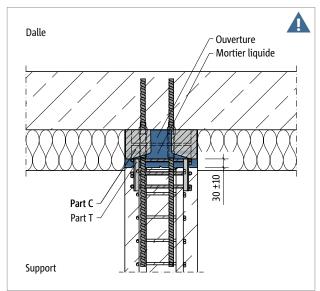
Schöck Sconnex® type P : coupe de montage ; raccordement poteau - dalle avec liaison mécanique avec le béton du poteau par le scellement en PAGEL® V1/50
